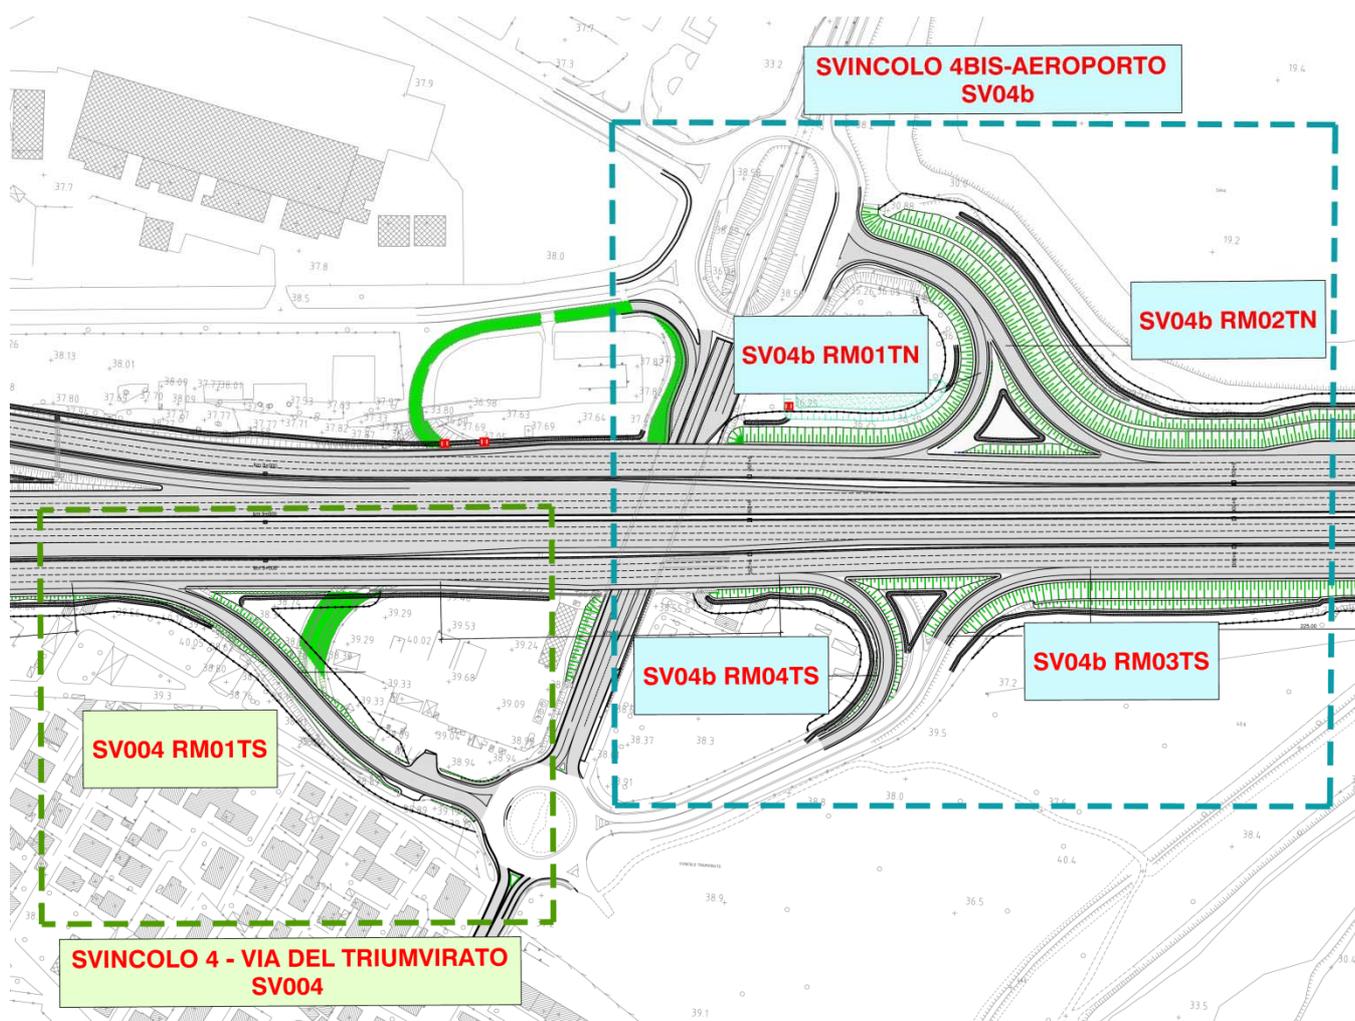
Stralcio planimetrico svincolo n.4 e 4 bis
